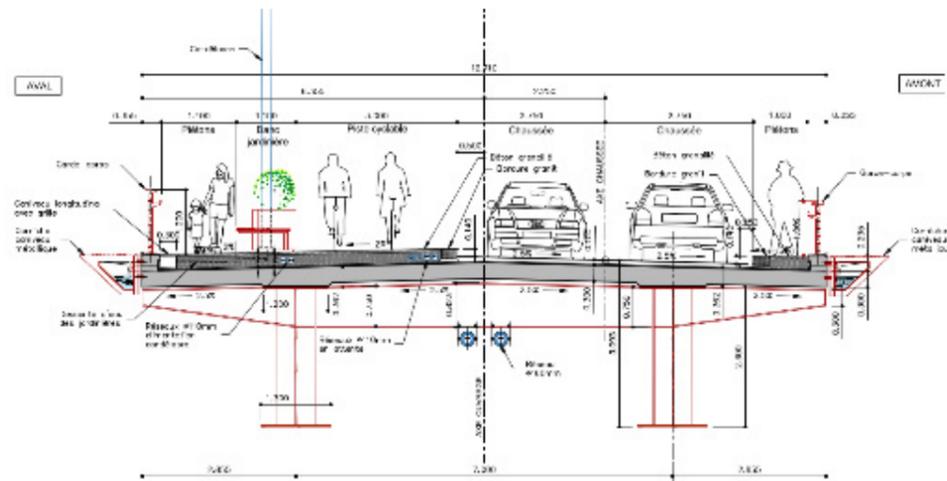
système de recueil des eaux pluviales - Extrait Plans AVP (Ingérop)
